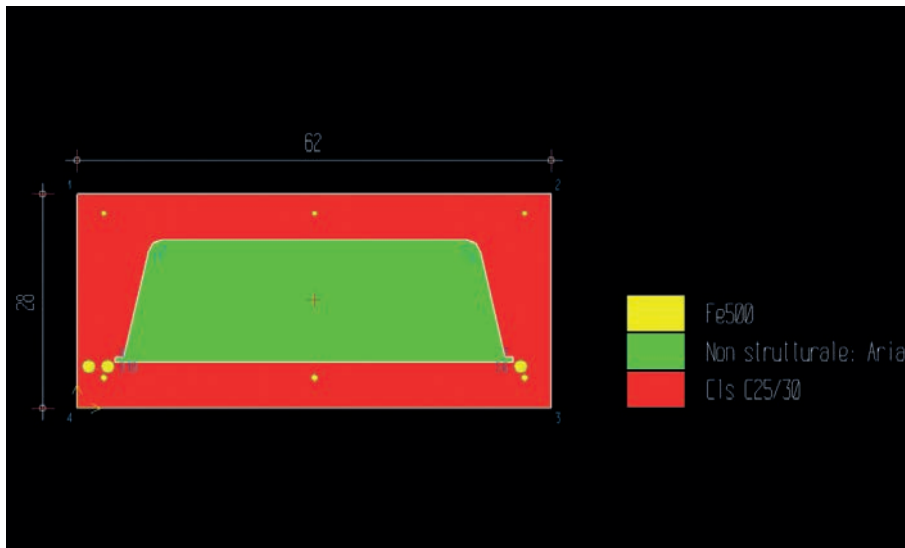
modellazione della sezione trasversale del solaio (vuoto, calcestruzzo e acciaio)
